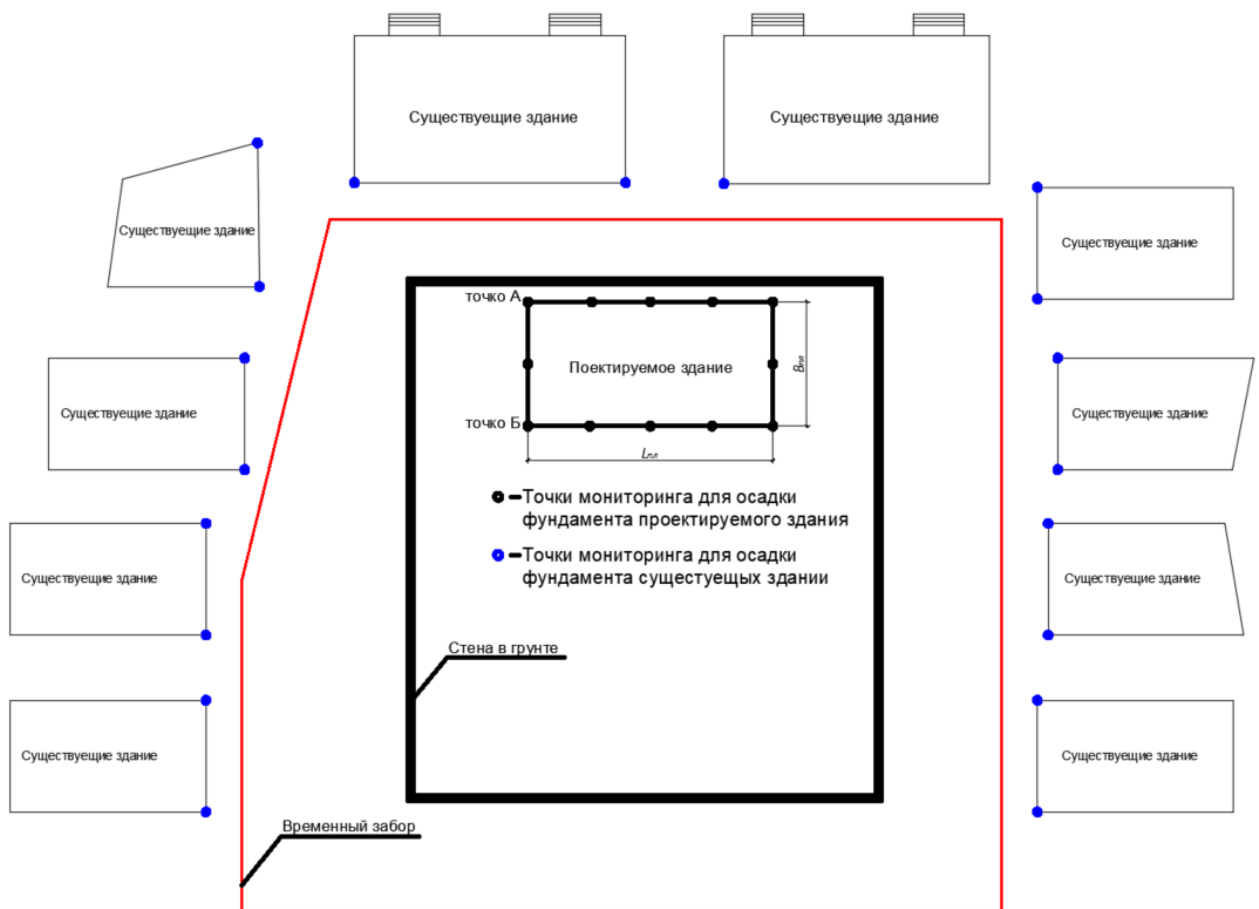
Генеральный план строительной площадки жилого комплекса
